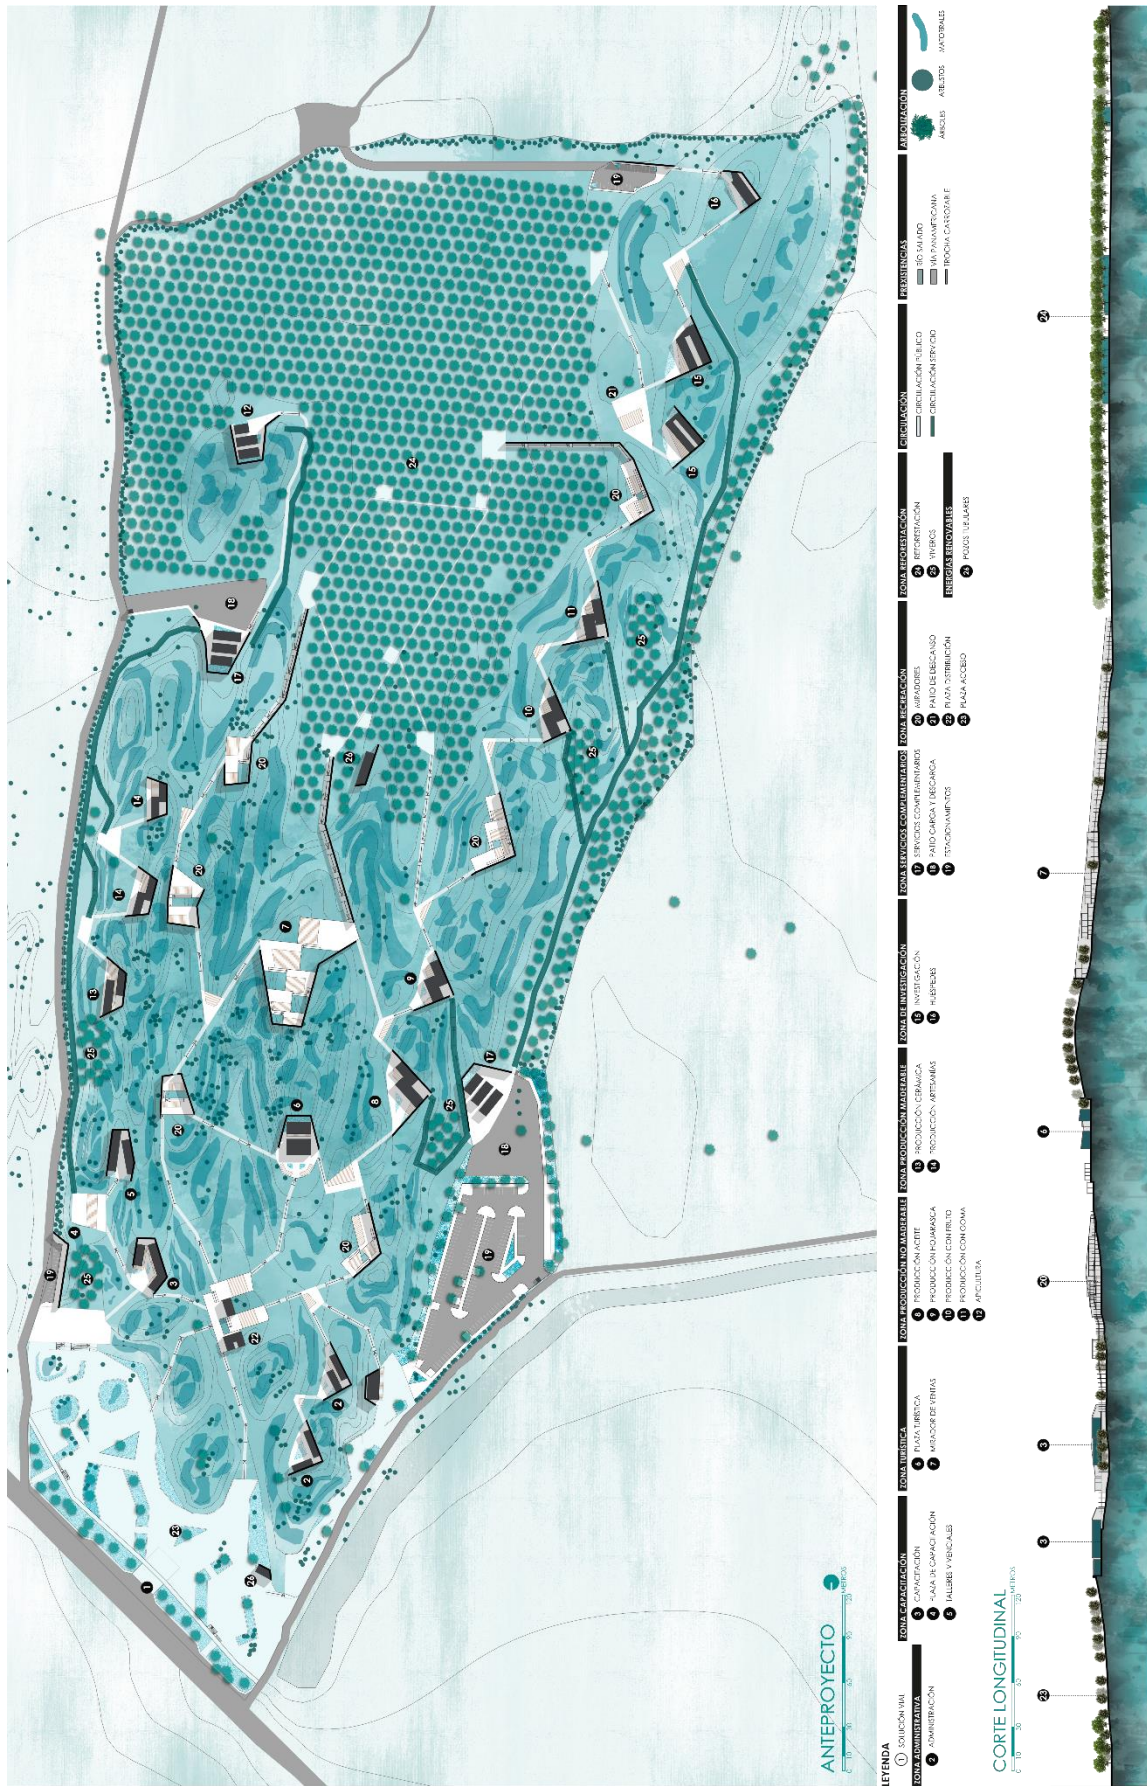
Plano anteproyecto/ Fuente: Elaboración propia
